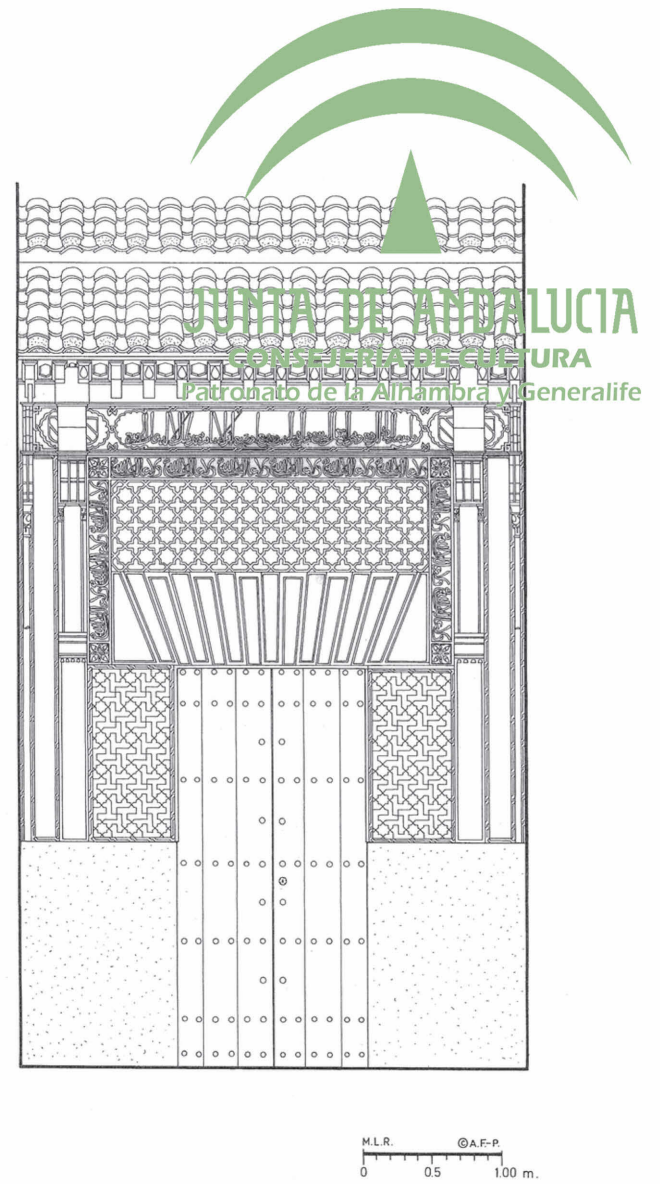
Fachada del Mexuar, 1362-1363. Elevación.
